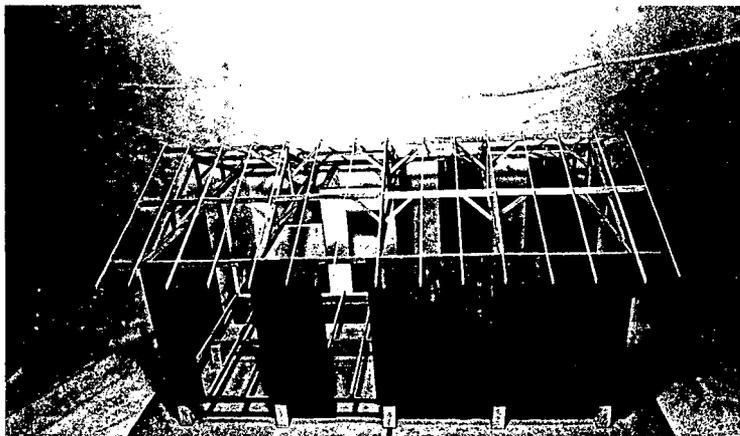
Colocação dos sarrafos apoiados nas terças.
